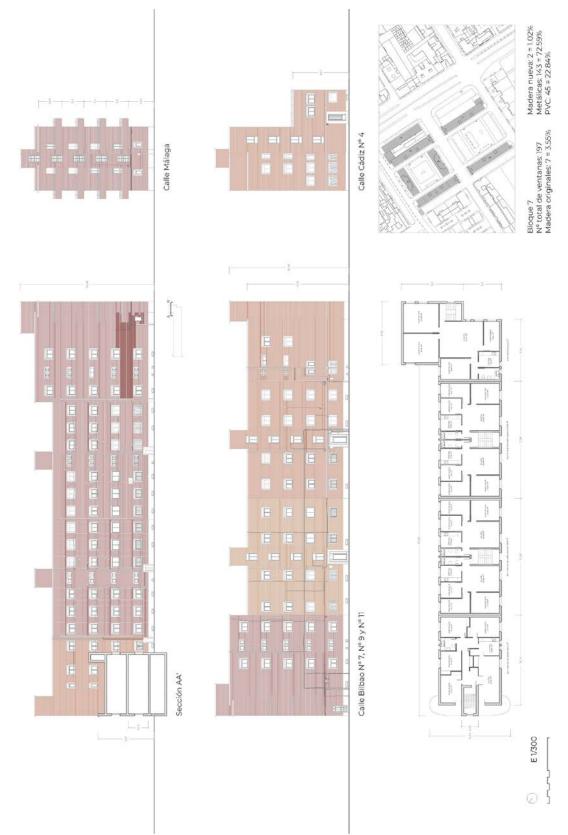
c.24. Planimetría del BLOQUE 7. Obra del Hogar Nacional Sindicalista
